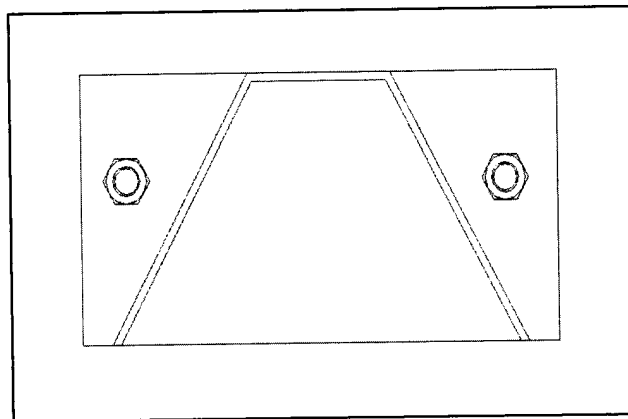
Assemblage soudé du cadre avec l'IPE
